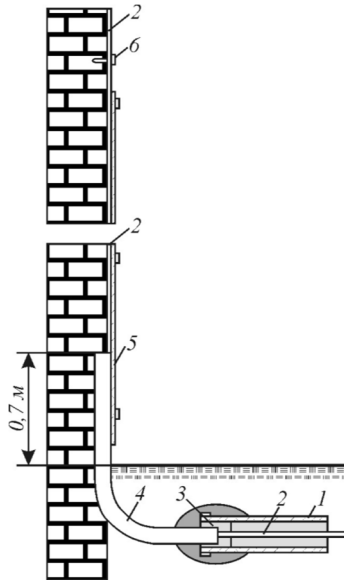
Правила организации вывода кабеля на наружную стену зданий:
